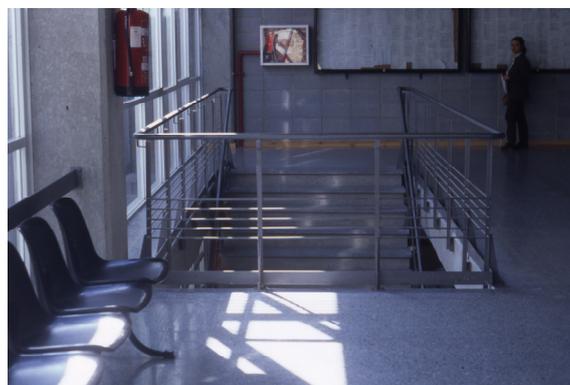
Detalle del interior del aula donde puede observarse que las instalaciones se han dejado vistas).
